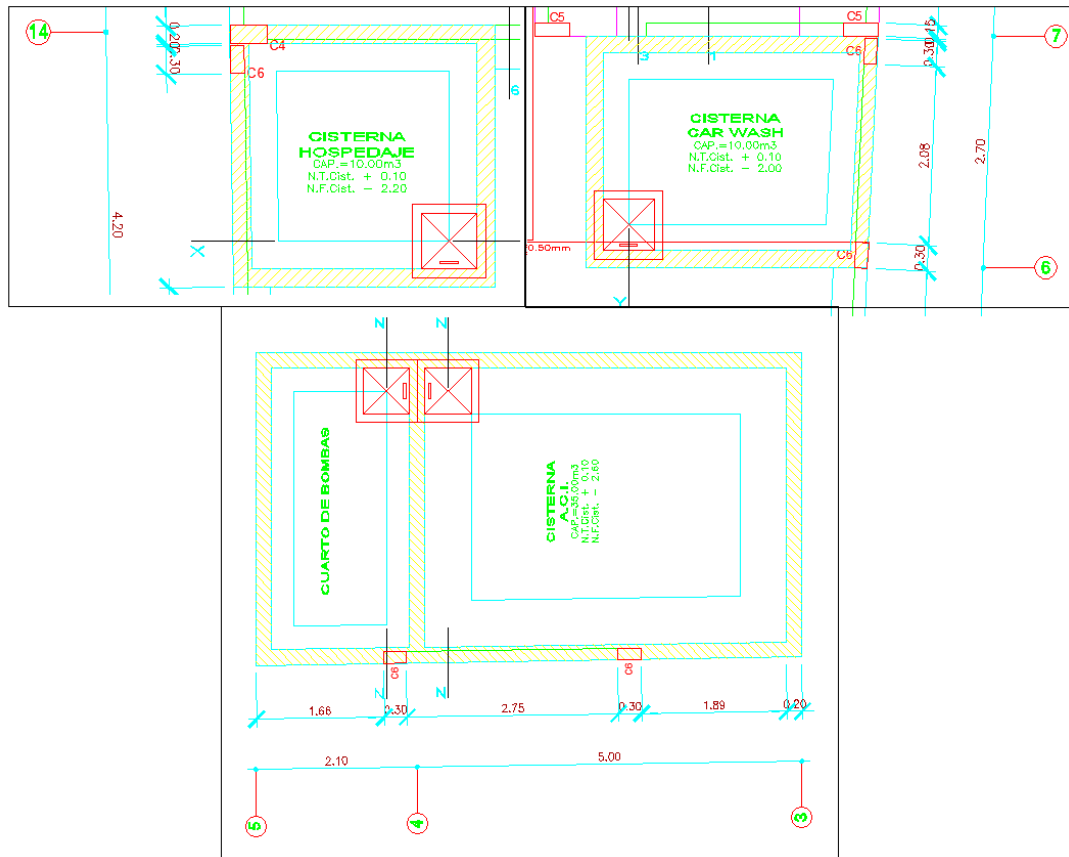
Cisternas del proyecto (Anexado en el plano A-01)
